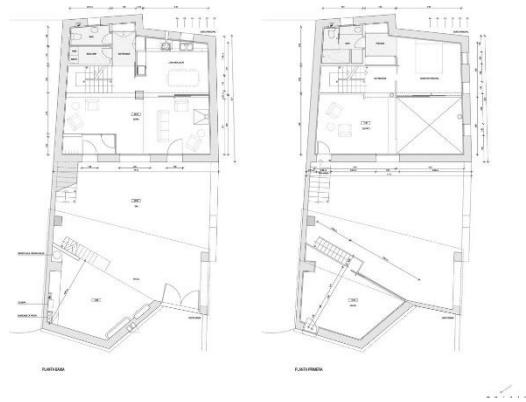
Planta baja y primera [Garcés de Seta Bonet]
